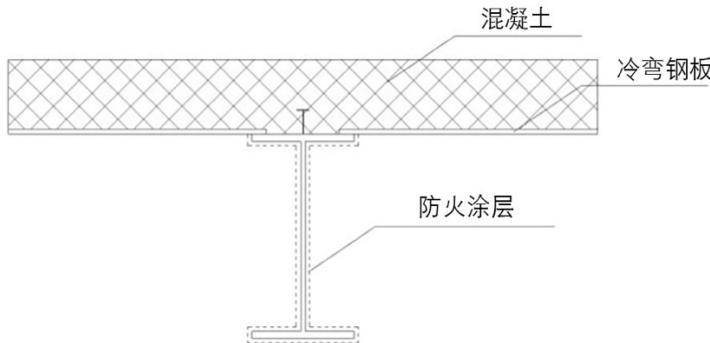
混凝土楼板和钢梁处常见的施工详图，采用冷弯钢板作为混凝土浇筑模板，同时需要在钢梁上喷涂防火层。 ©ZHAW
